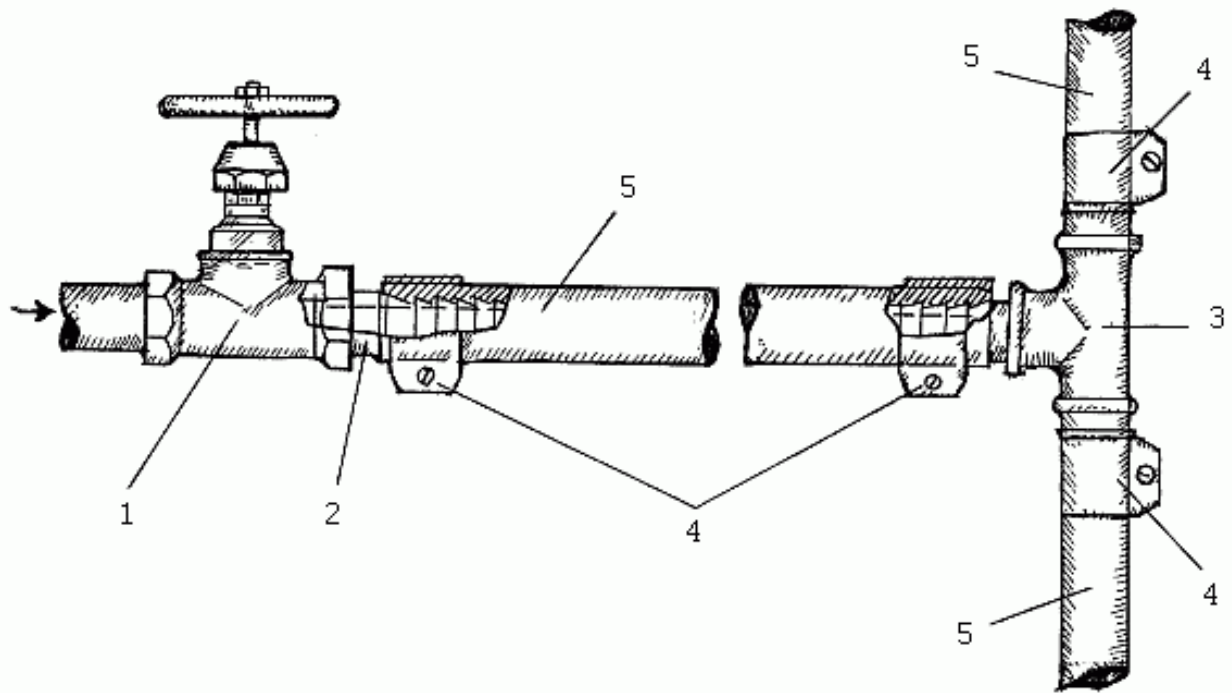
Соединение резинового водопровода: 1 – вентиль; 2 – переходник; 3 – тройник; 4 – хомут; 5 – шланг
